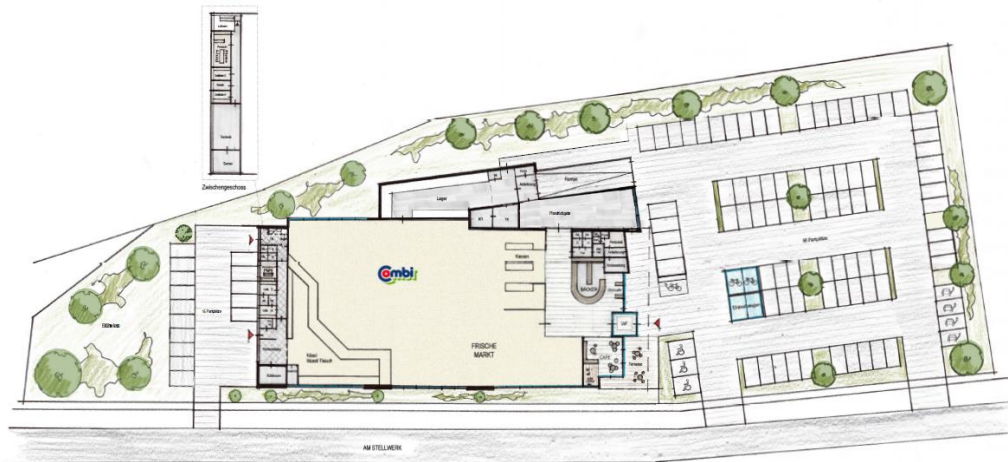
Lageplan / Grundriss des Combi-Markt-Vorhabens (Quelle: db Bau)
